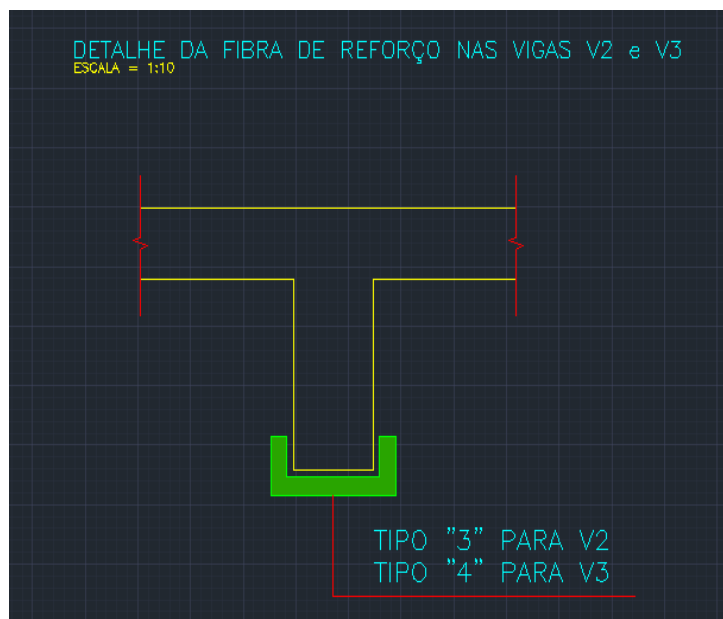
Corte das vigas V2 e V3 e o respectivo reforço
